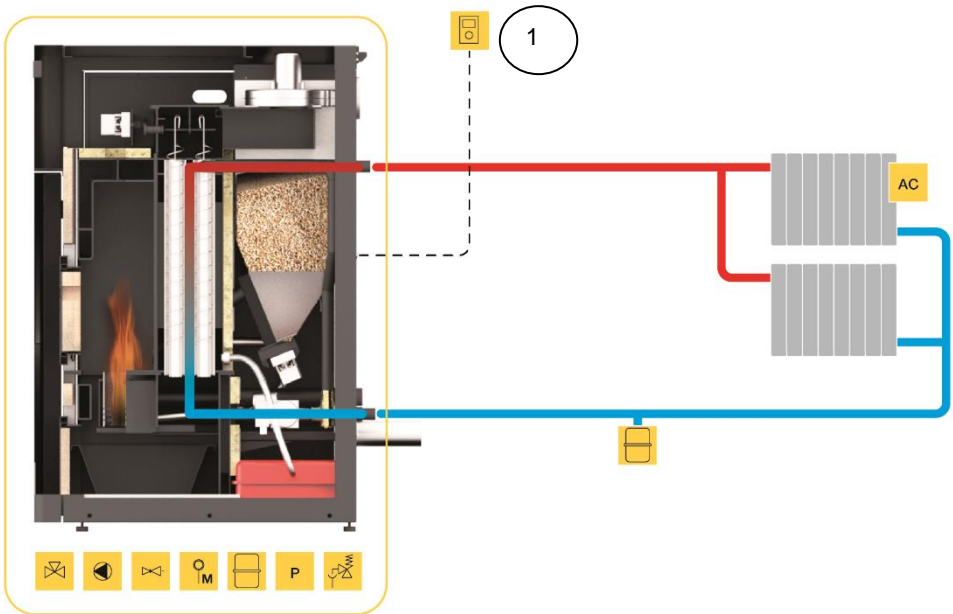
Ligação simples apenas a radiadores de aquecimento central
